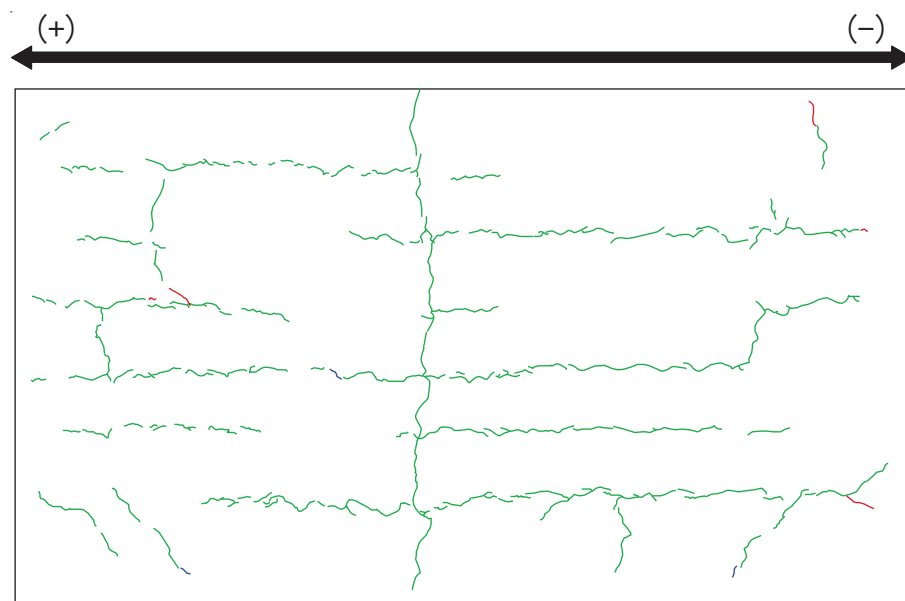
(2) 乾燥試験体 [1] 1/10000rad. におけるひび割れ図
